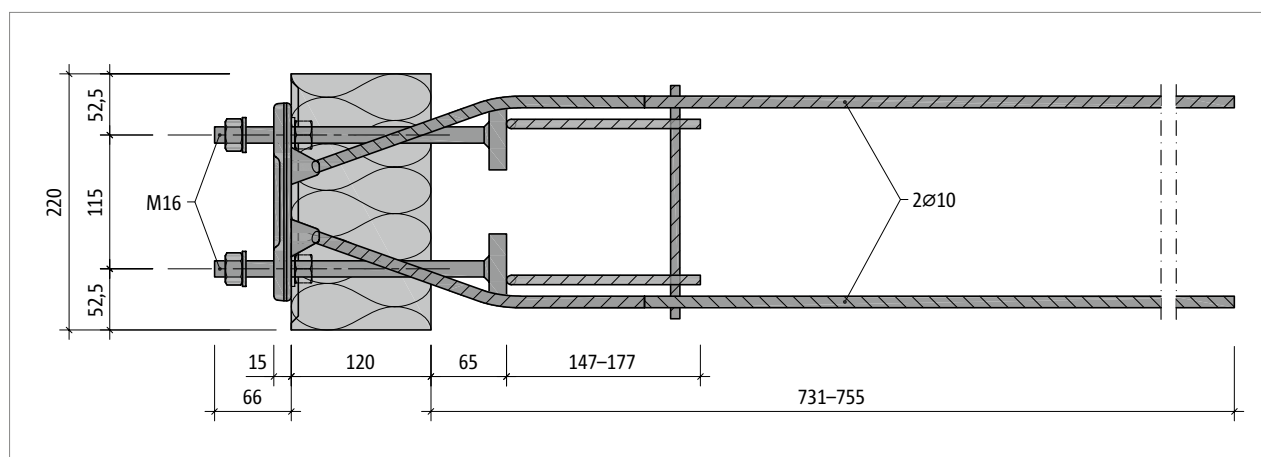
Schöck Isokorb® XT type SQ-V2 : vue en plan
